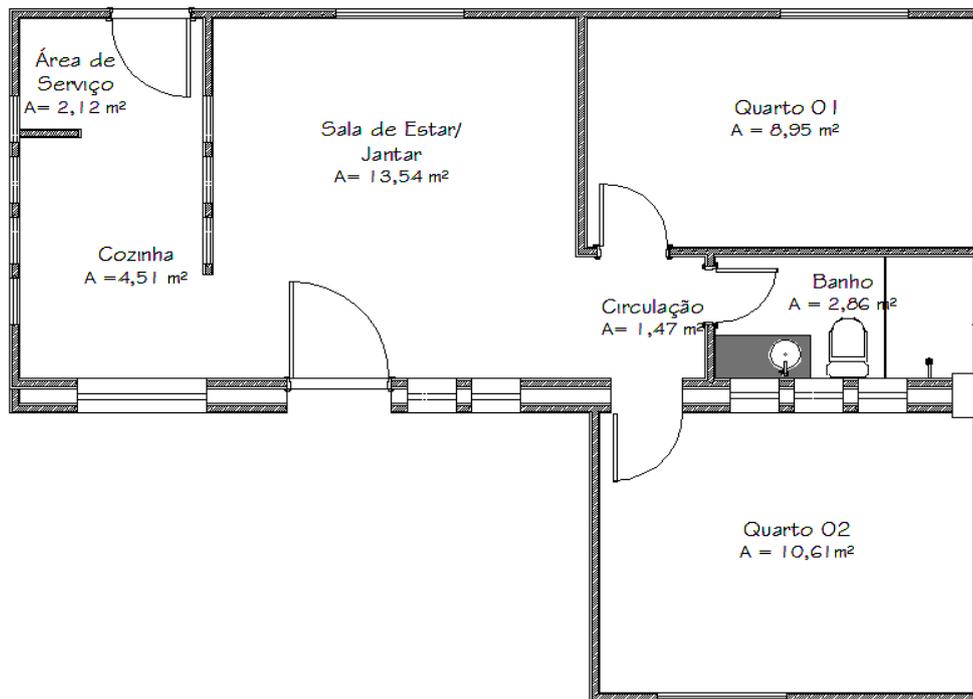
Versão do projeto modelo com paredes em tijolo cerâmico.
